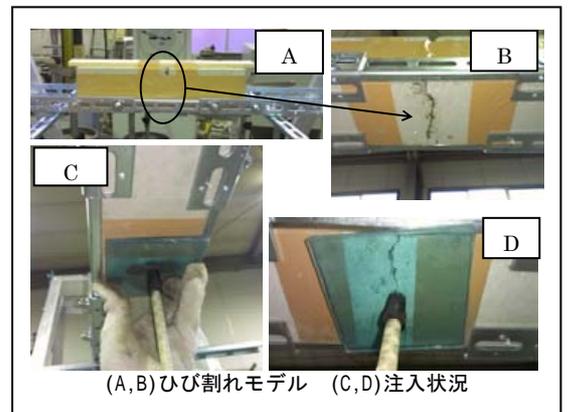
ひび割れモデル及び補修材注入状況
